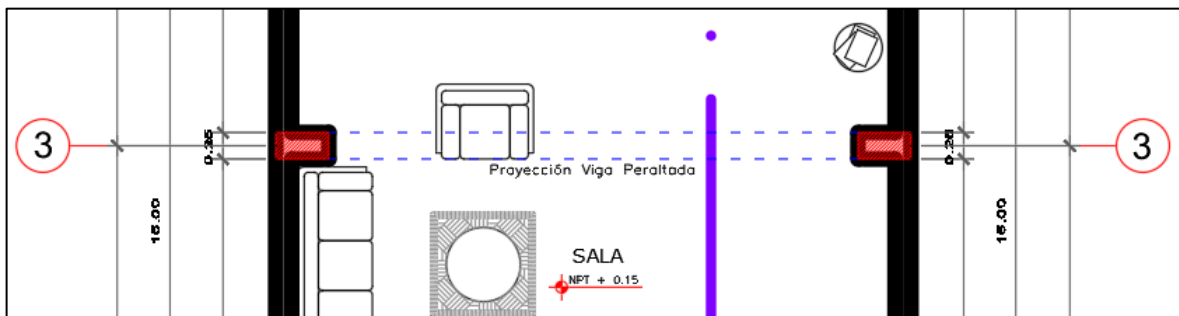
Detalle de predimensionamiento de Columna Perimetral eje 3
